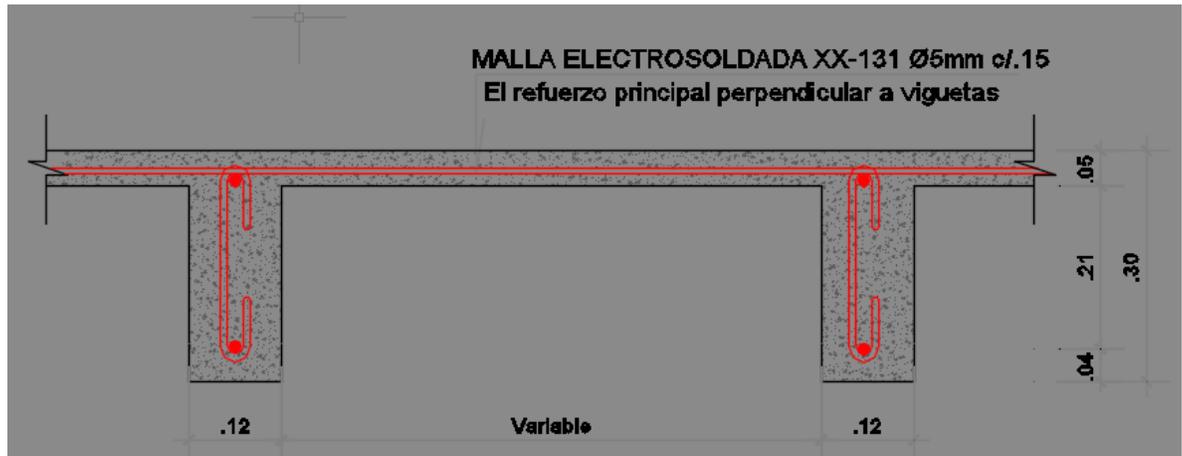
Sección Transversal de Placa de Entrepiso y Viguetas.
